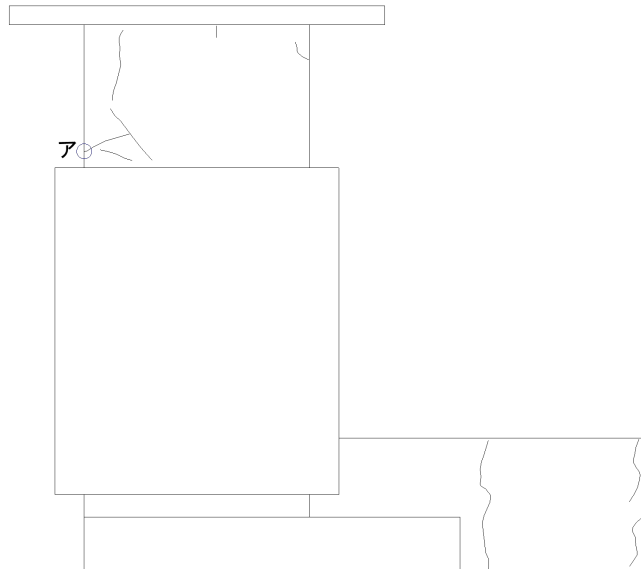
柱ひび割れ幅測定位置(試験体 C-2 正載荷)
